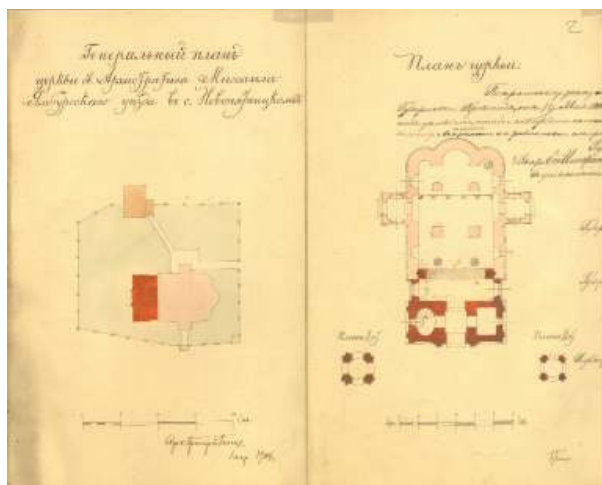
Генеральный план и план церкви с проектом колокольни 1904 г.
